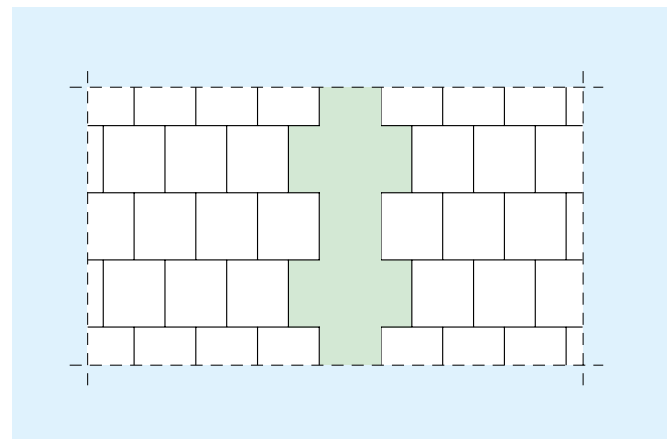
Rissrisiko beim nachträglichen Betonieren von Stahlbetonstützen im Verband mit Mauerwerk
